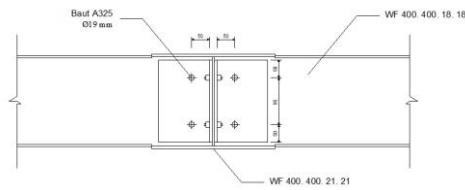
Sambungan Balok Induk Lantai dengan Balok Anak Lantai
